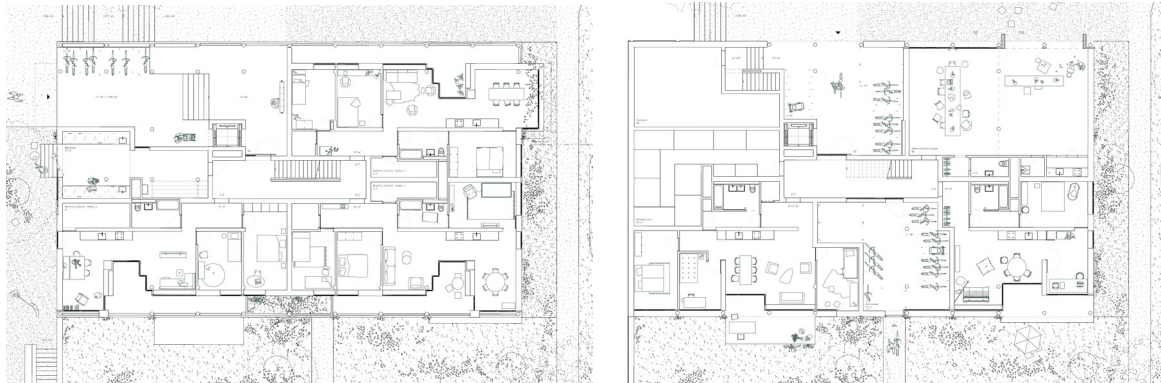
Grundrisse Gassengeschoss (links) und Gartengeschoss (rechts), ohne Masstab
